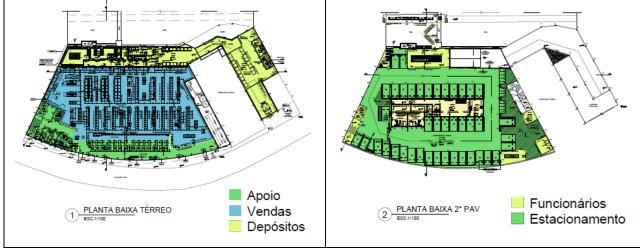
Planta Baixa Térreo e 2º Pavimento
